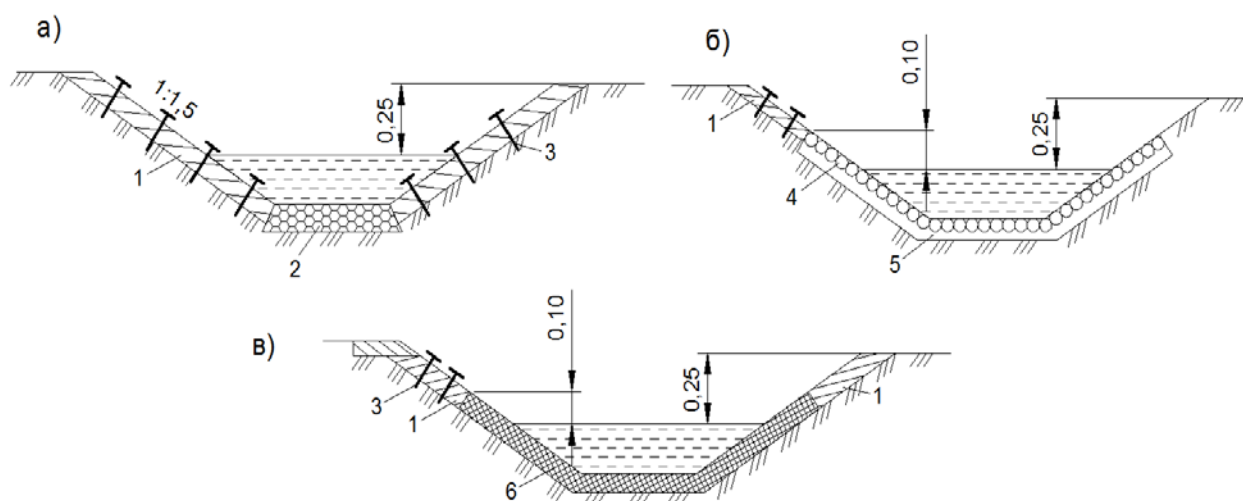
Схемы укрепления водоотводных канав: а) сплошной одерновкой; б) мощением; в) грунтом, обработанным вяжущим материалом; 1- дерн толщиной 8-10 см; 2 – щебень или гравий; 3- деревянные колышки; 4 - камень слоем 12-16 см; 5 - геосинтетический материал или солома; 6 - слой грунта, обработанного вяжущим, толщиной 5-10 см.
